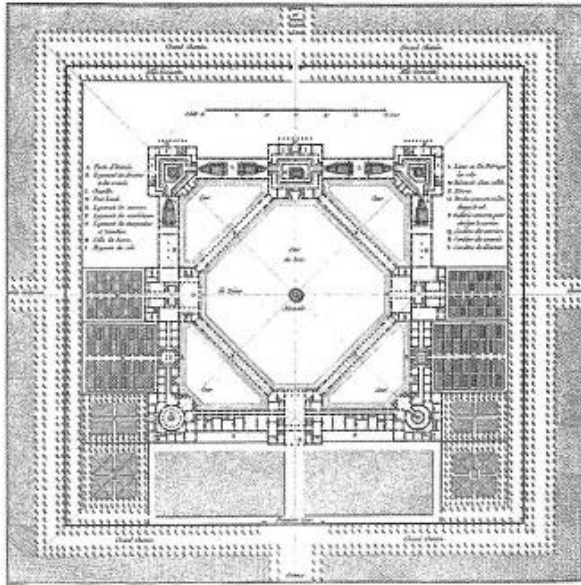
Claude-Nicolas Ledoux, salinas de Chaux, planta del primer proyecto no construido, 1773- 1774.
